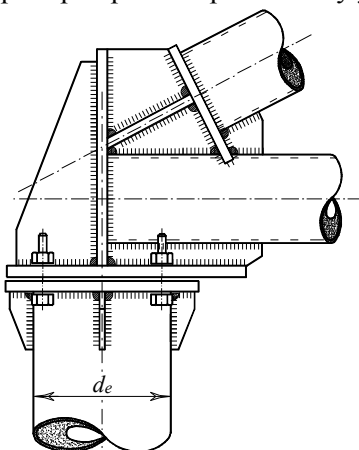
Опорный узел центрифугированной трубобетонной фермы
